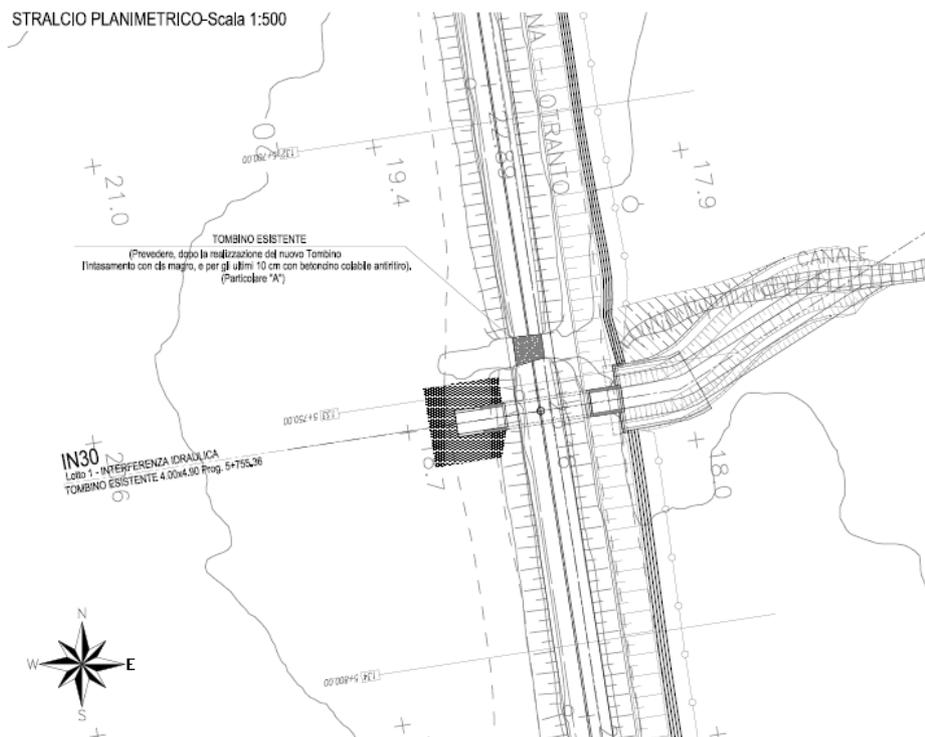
Scatolare km 5+755 – Vista Planimetrica
